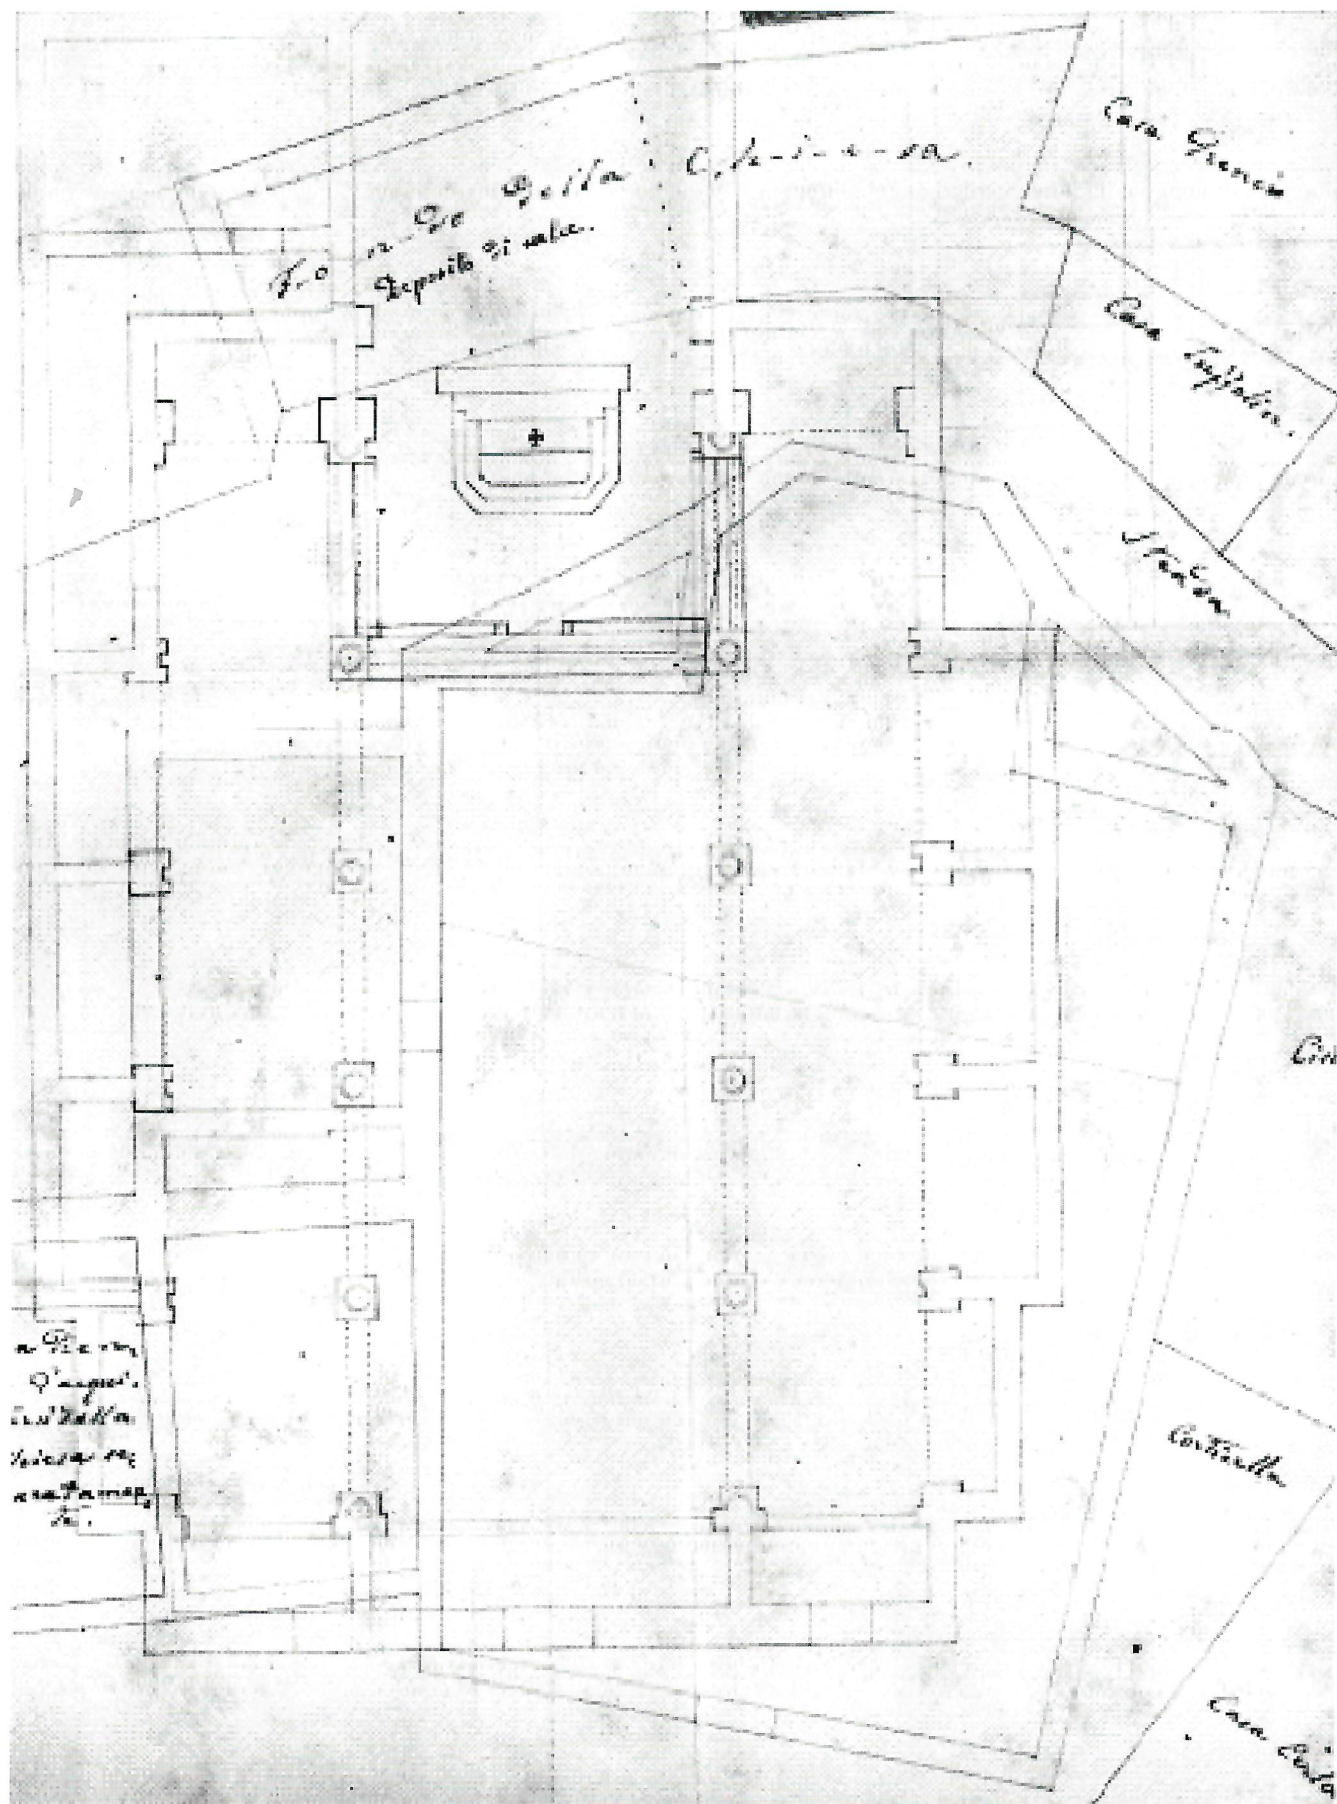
Particolare della tavola XII del progetto raffigurante la pianta della nuova chiesa.
